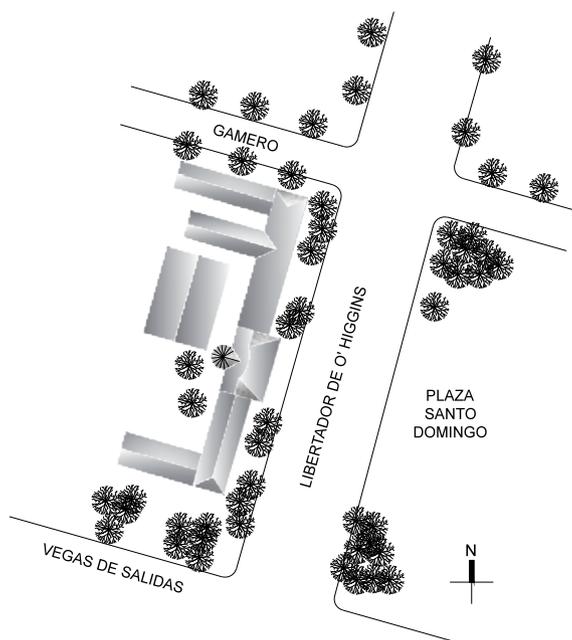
Planta de conjunto, Escuela México, Chillán, Chile.
